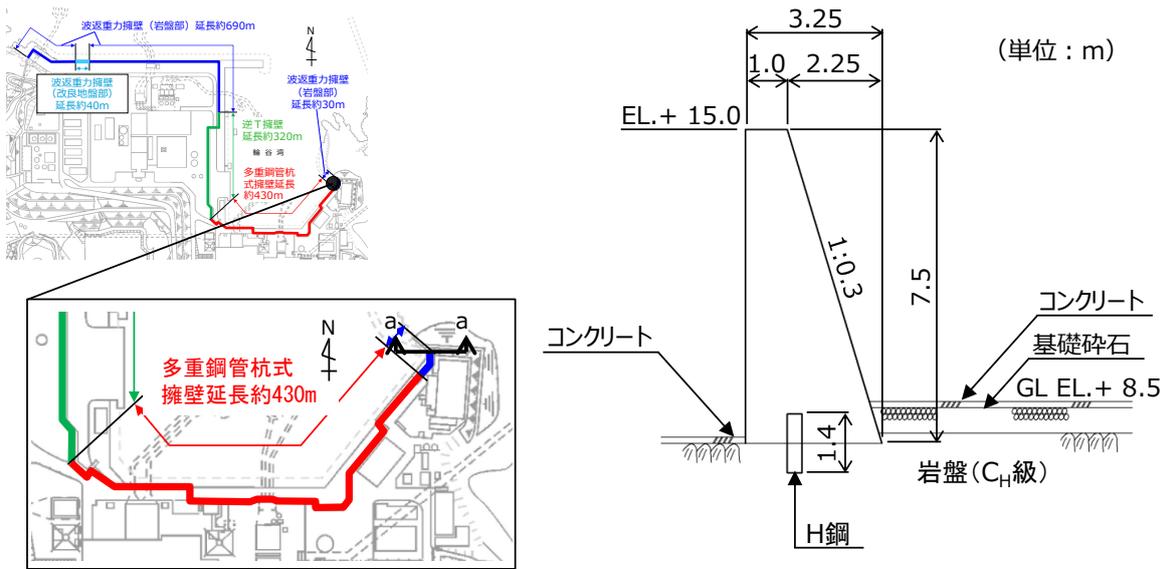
17 防波壁 (波返重力擁壁) 東端部 (a-a 断面) 断面図
